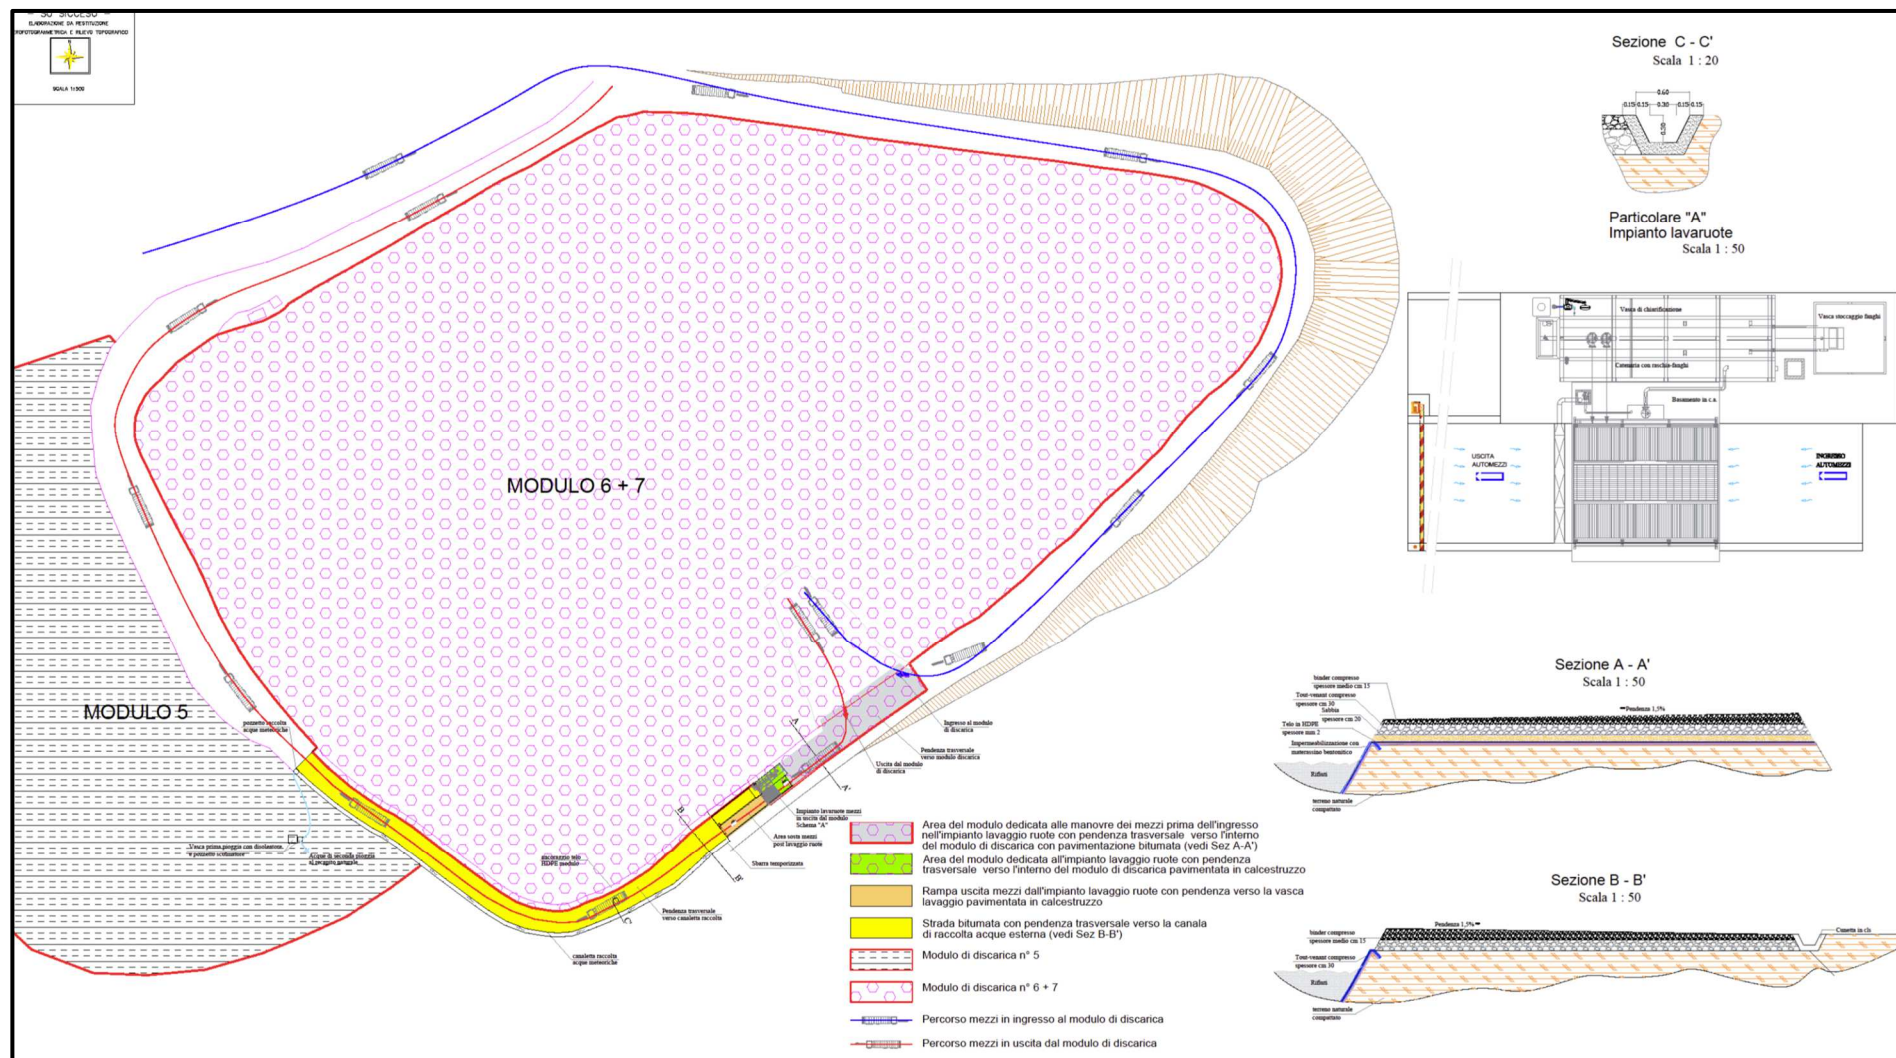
/II: Impianto lavaggio ruote e pavimentazione piste
